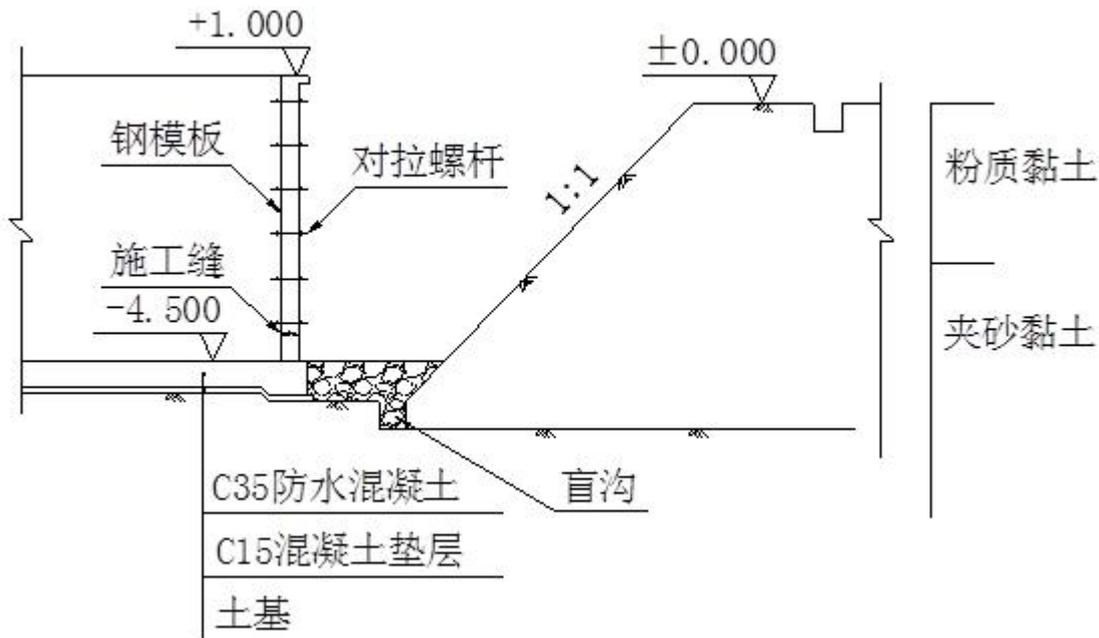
混凝沉淀池施工横断面示意图 (单位: m)
